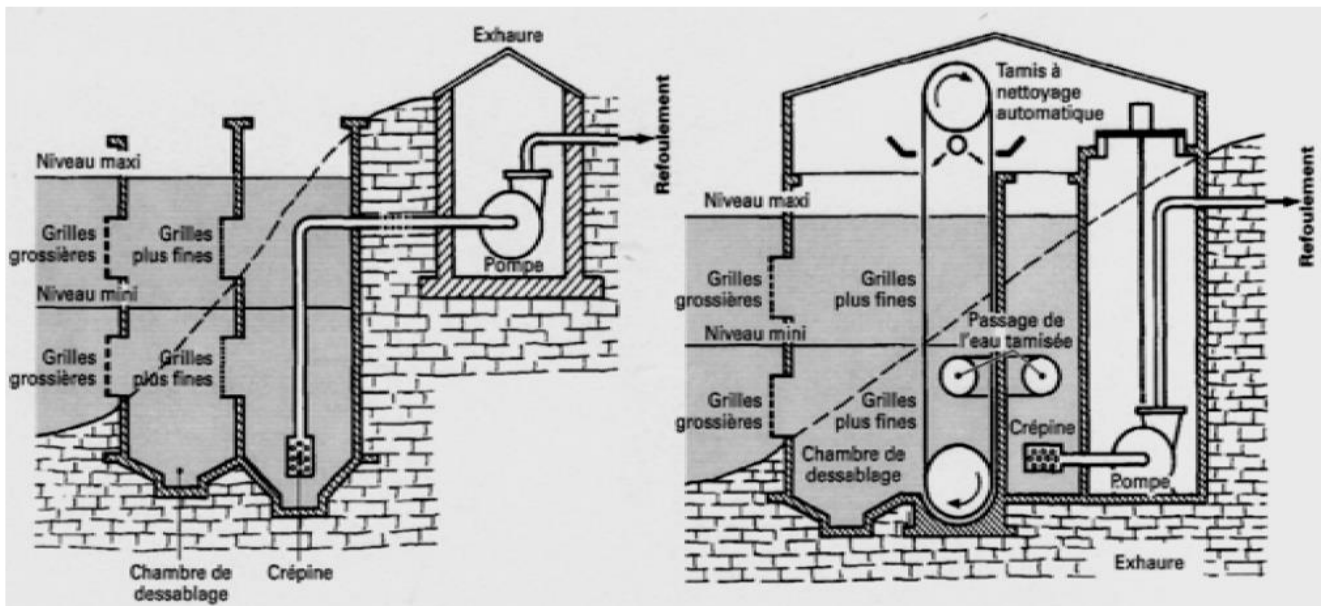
Ouvrages de prise d'eau au voisinage de la berge d'une rivière.
